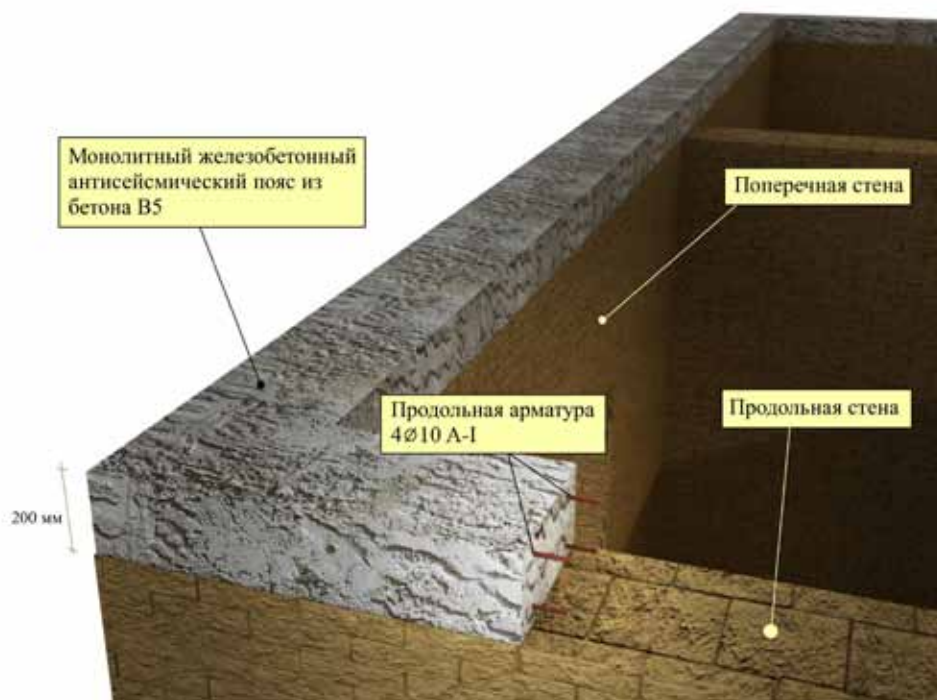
Антисейсмический пояс из монолитного железобетона
